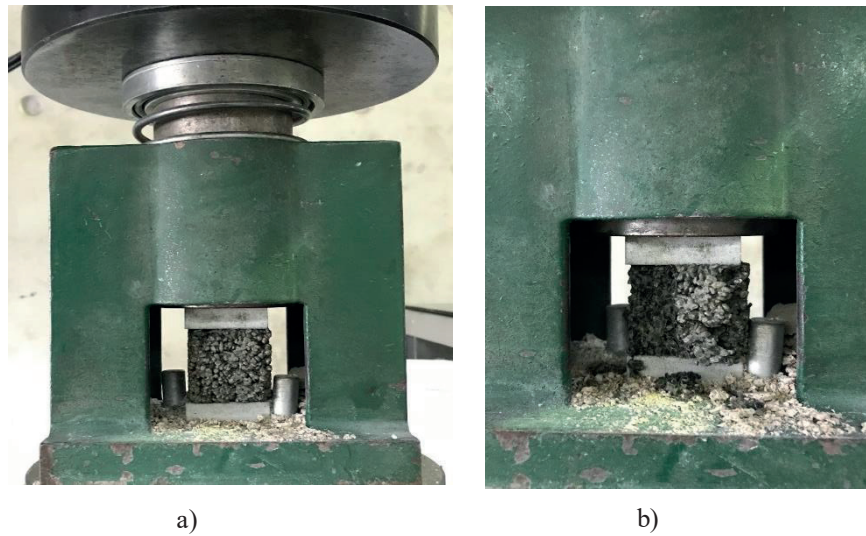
a) Ensaio de compressão antes da aplicação do carregamento; b) Amostra na fase de rotura após a aplicação do carregamento.
